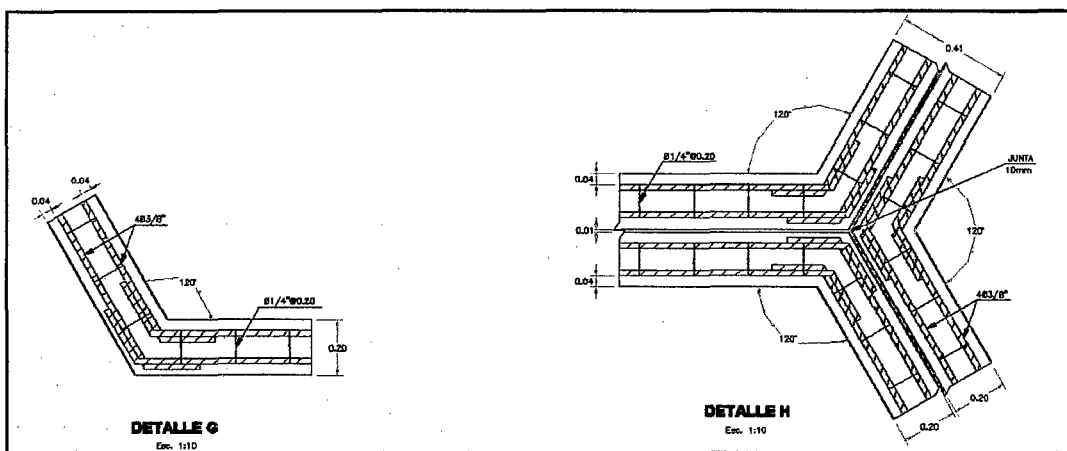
Vista en planta de los detalles G y H de la Figura 6.36.
